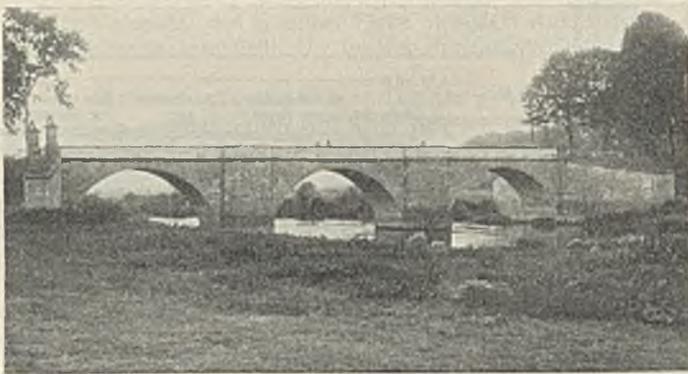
Große Leinebrücke vor dem Umbau von Unterwasser.
